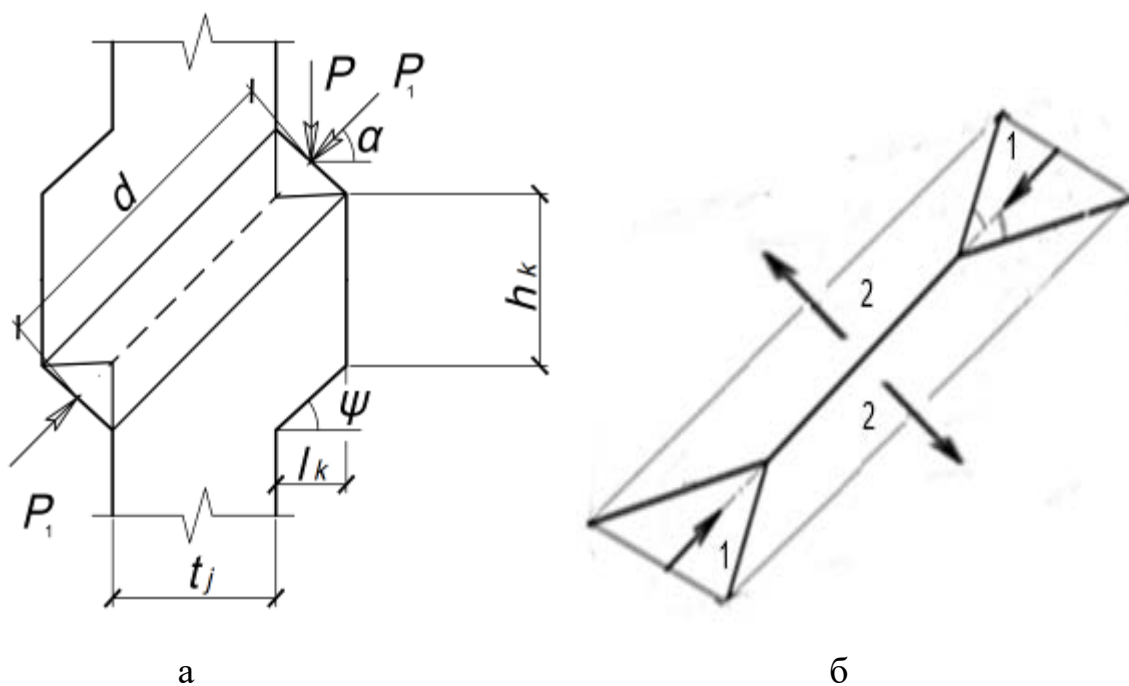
Руйнування шпонкового шва (а); кінематичний механізм (б)
